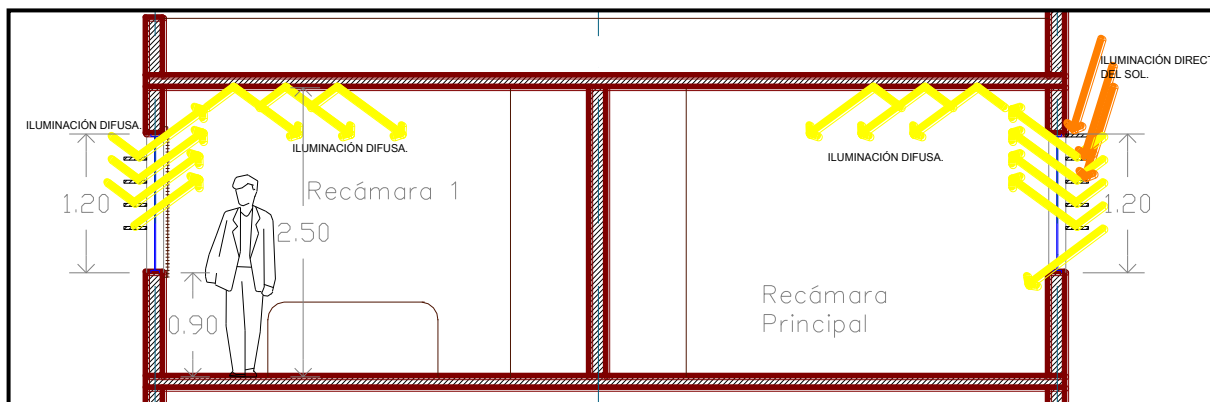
Proyección de la iluminación en las recámaras de la planta alta.
